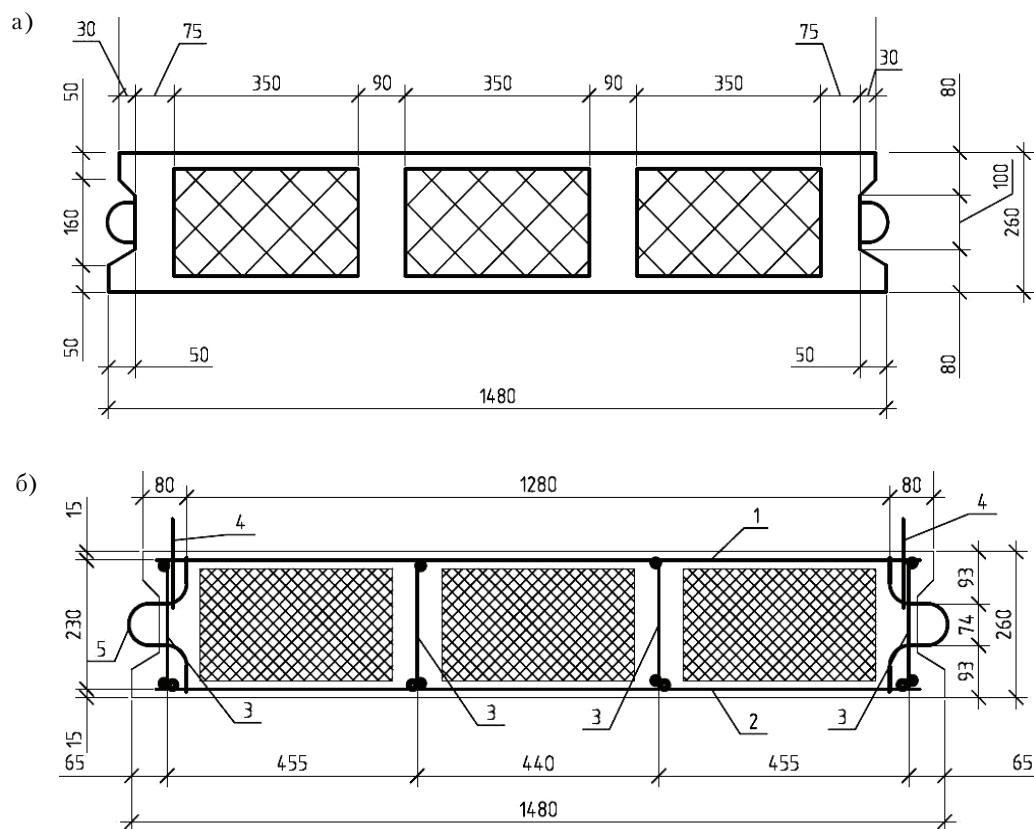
Опалубочная схема (а) и схема армирования (б) многослойной плиты покрытия.
